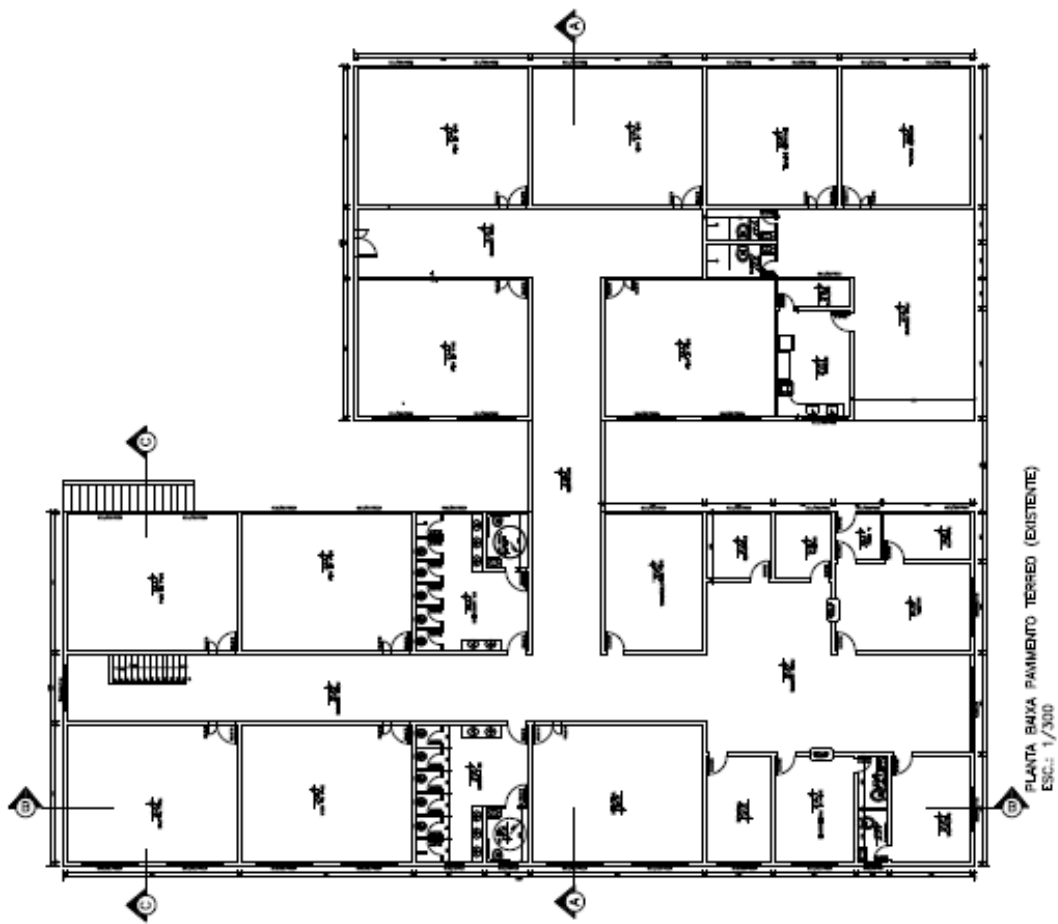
Planta baixa - primeiro pavimento - ESCOLA 3
